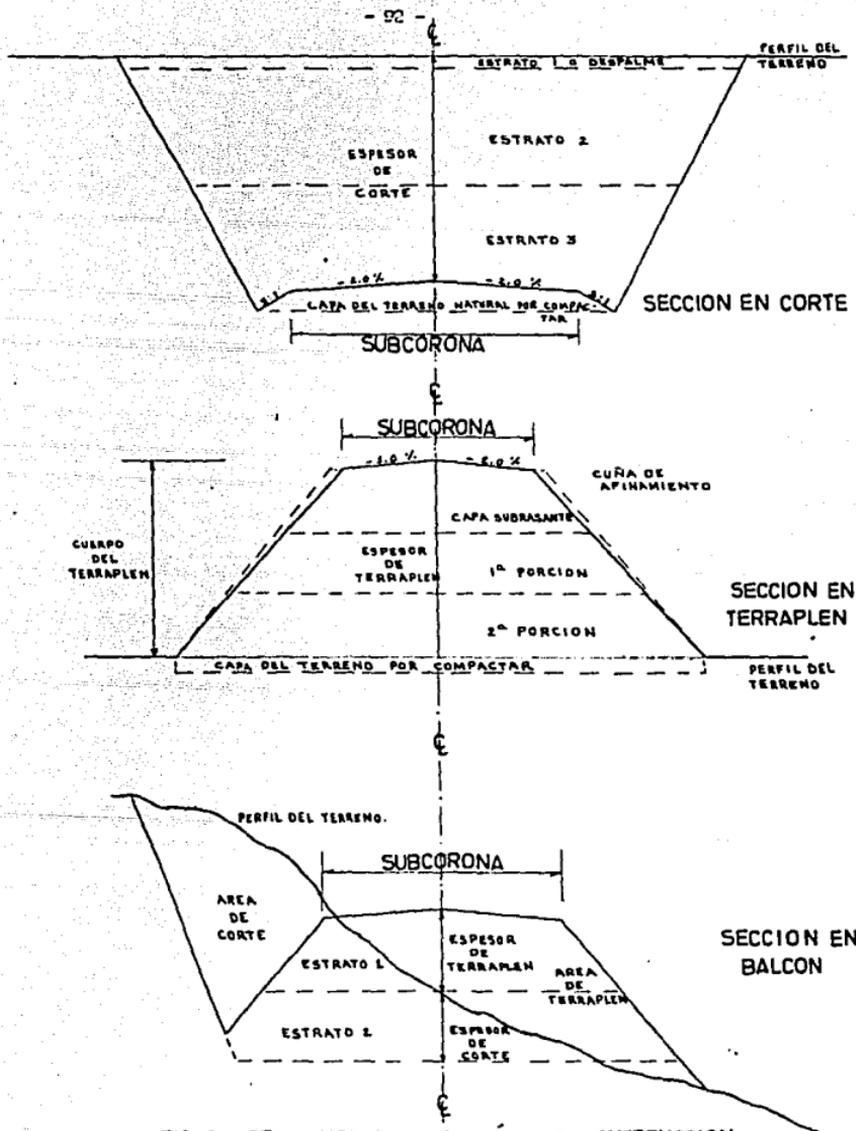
SECCIONES TRANSVERSALES DE CONSTRUCCION
